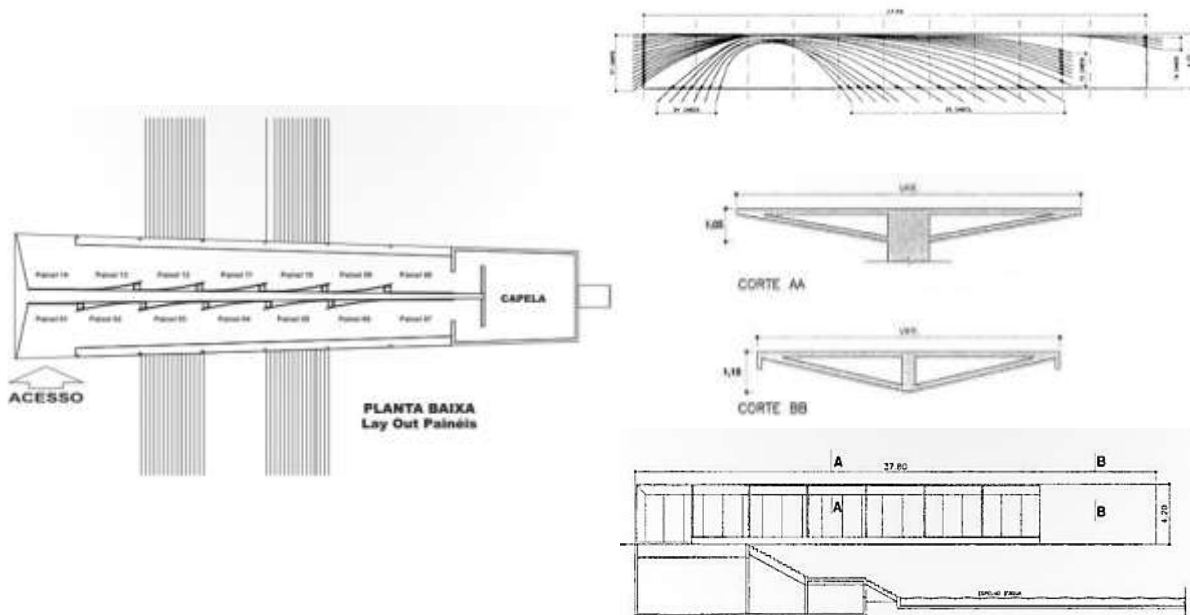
Em cima, planta baixa mostrando o ligeiro afunilamento da estrutura que diminui carga; esquema de protensão dos cabos na parede-viga que divide verticalmente o volume; cortes da viga-teto em 'V' e vista lateral com o declive. Em baixo, os pilaretes onde a parede-viga não comparece. O lastro que prende o volume ao solo, a medir pelas plantas, tem apenas 21% de área de contato.
